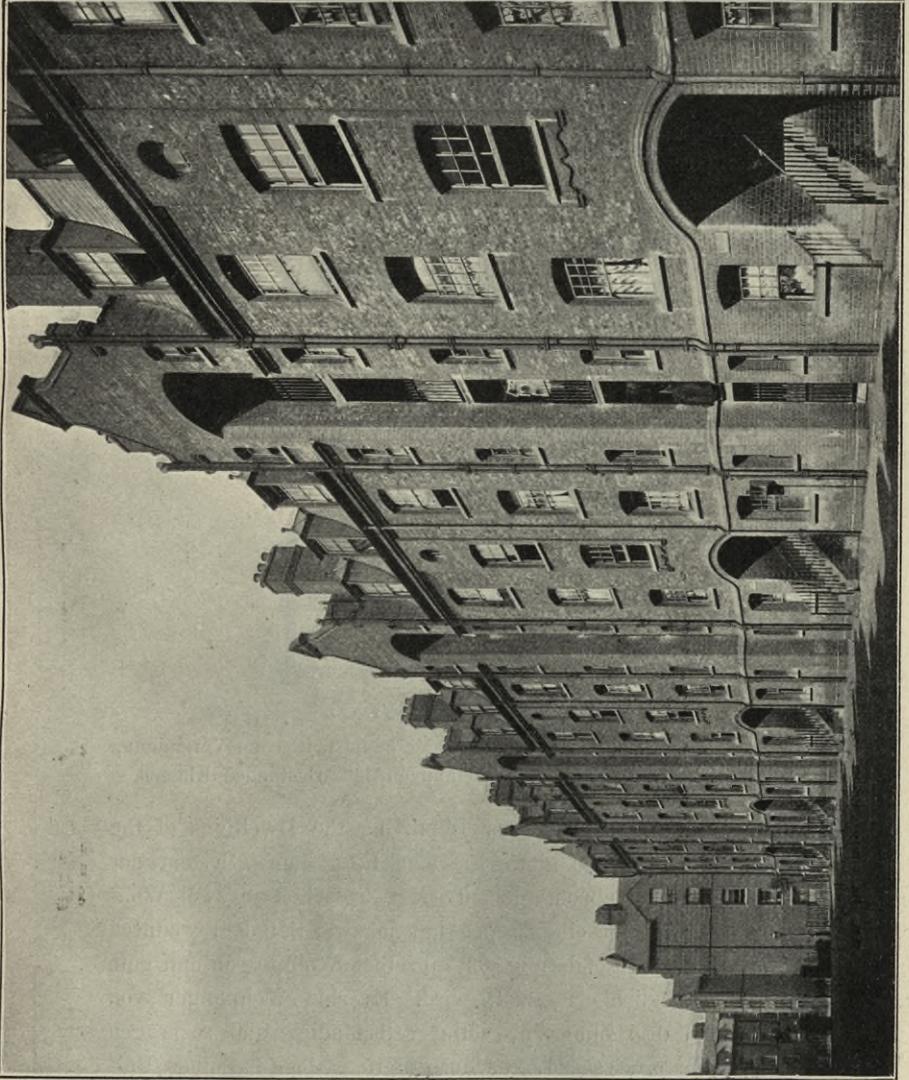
Gebäudegruppe auf dem Boundary-Street-Grundstück des Londoner Grafschaftsrates.
